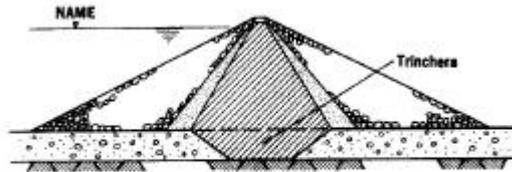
Presa de tierra y enrocamiento con trinchera
